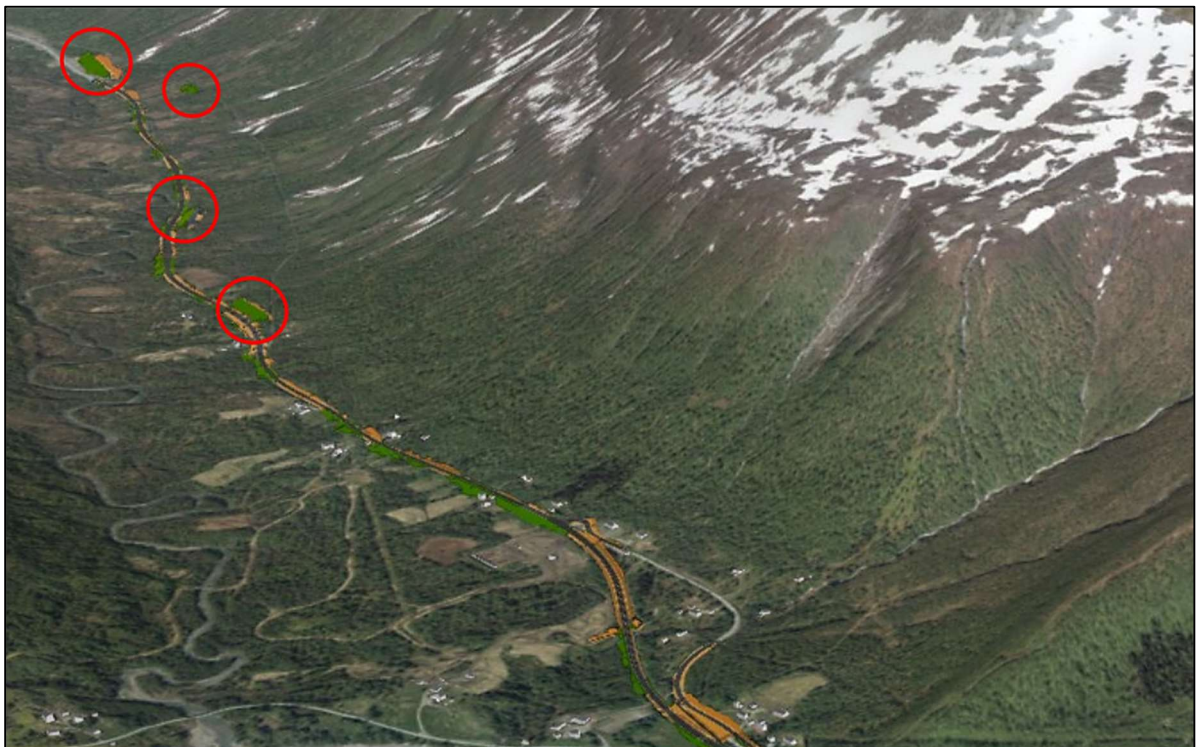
Ortofoto av planområdet. Planavgrensningen vist med gul linje.
